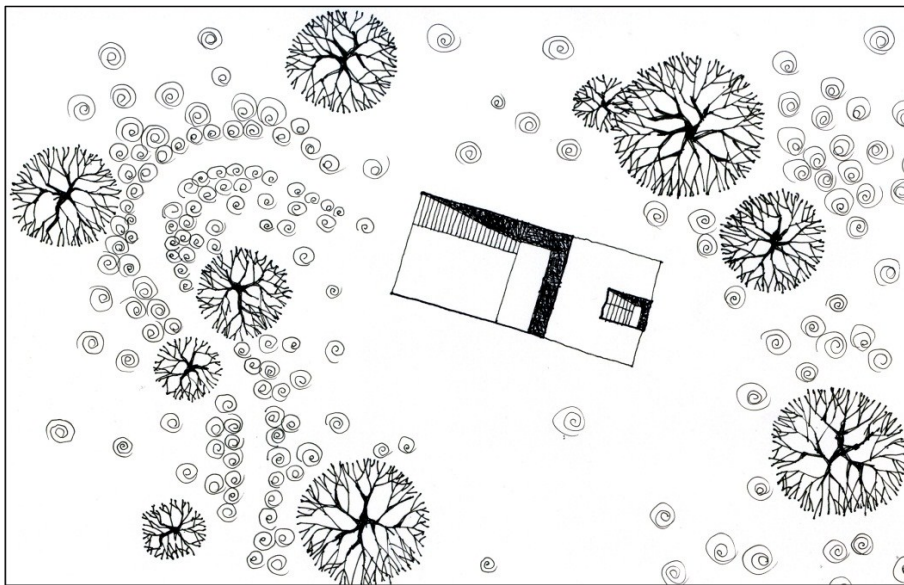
Quite time: Invisible house, Tokyo, Lageplan
